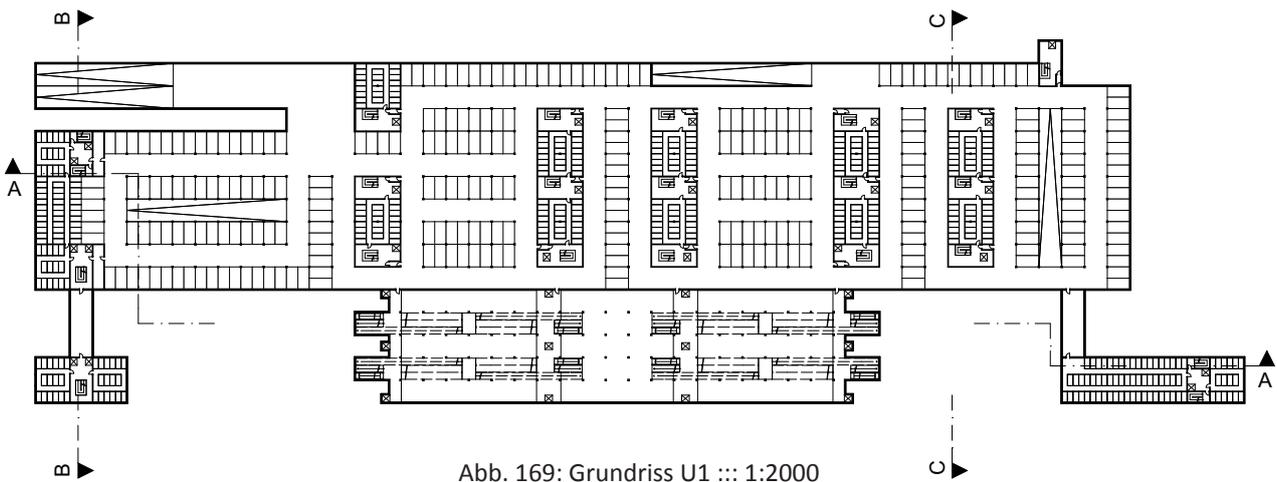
Grundriss U1 ::: 1:2000
